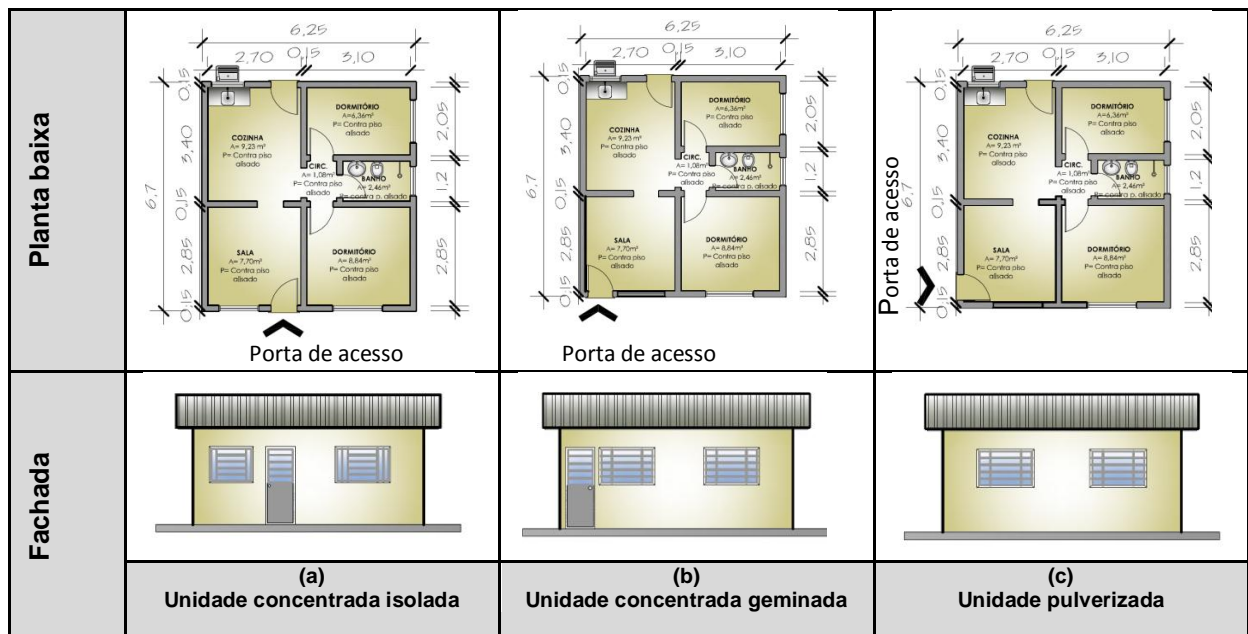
Planta Baixa e fachada das unidades habitacionais do Programa Minha Casa - variação somente na posição da porta de acesso principal: a) no centro da fachada frontal; b) no canto da fachada frontal e c) na fachada lateral.
